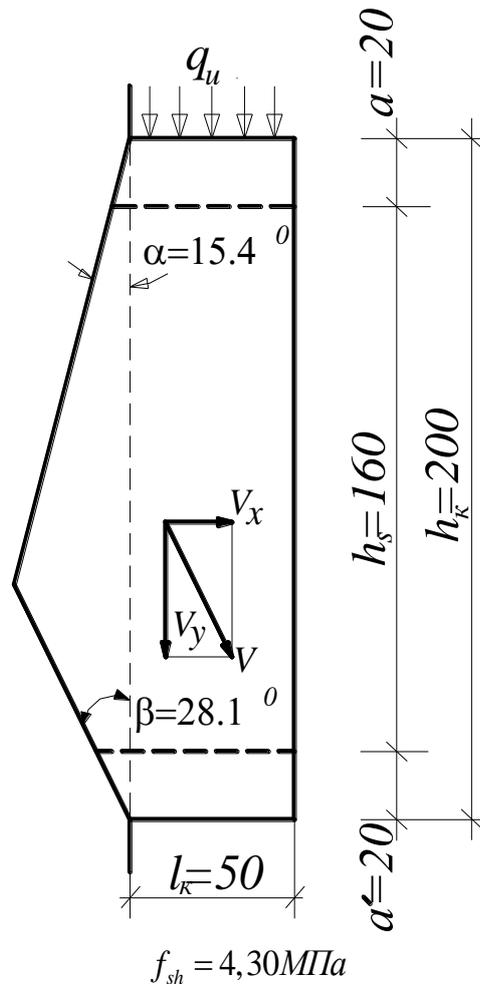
Параметри кінематичної схеми руйнування залізобетонної шпонки із розташуванням арматури у два яруси та врахуванні нагельного ефекту в арматурі, котра розташована у стиснутій зоні
